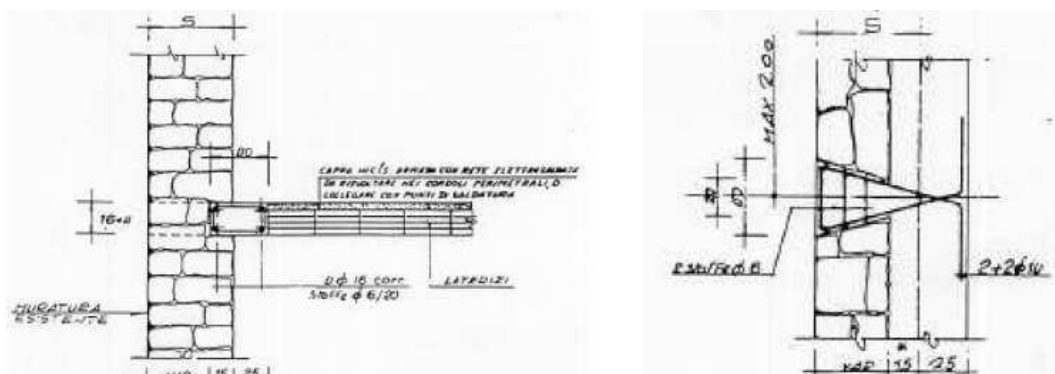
Particolare di solaio in laterocemento di nuova costruzione su muratura esistente; sezioni verticale e orizzontale (in diversa scala) con ancoraggio “a coda di rondine”
